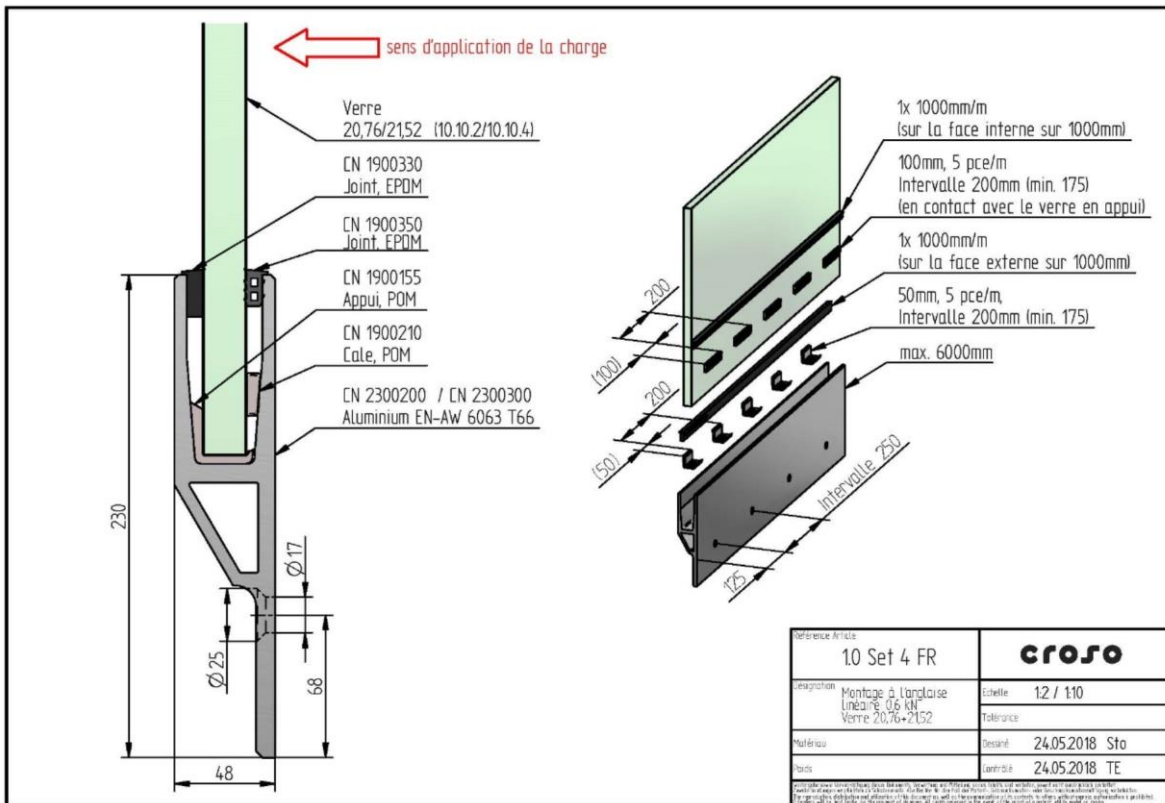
CROSILUX 1.0 - Montage en nez de dalle - Profilé renforcé
